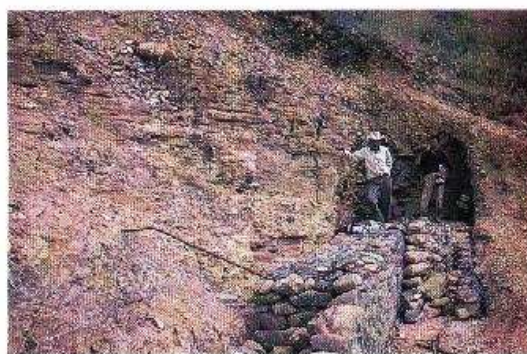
Vista desde el extremo de un muro de gaviones bajo construcción en una pendiente fuerte. Cochabamba, Bolivia. (Foto G. Bauer)
